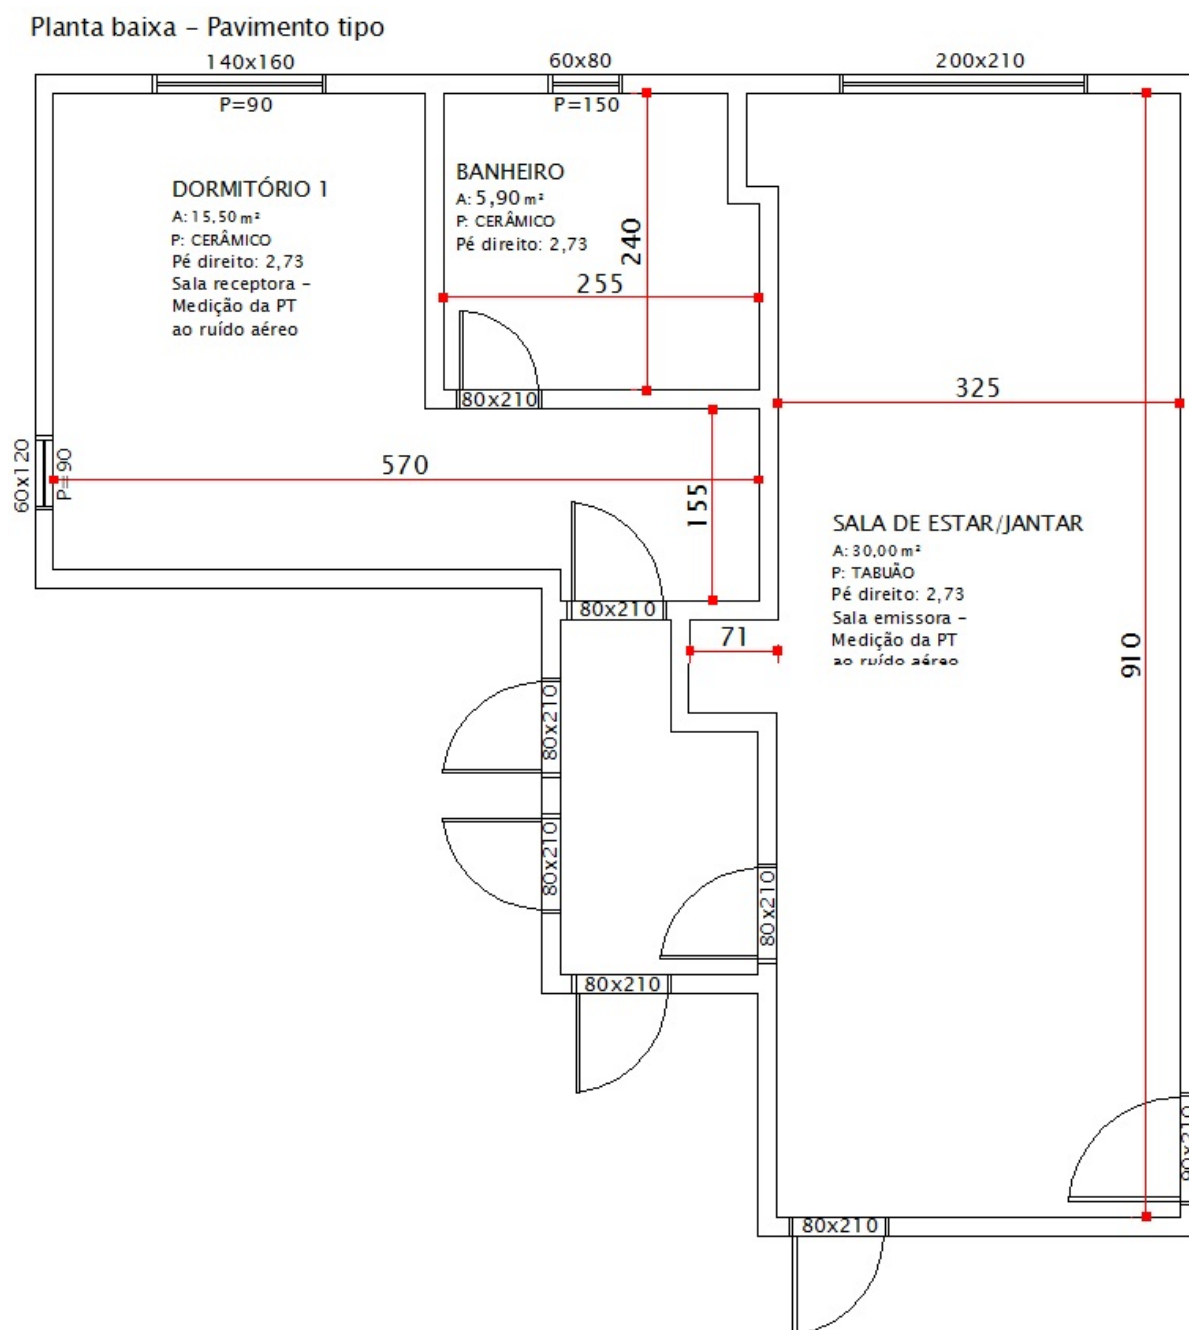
Planta baixa - pavimento tipo - 07-R8-N-TV
